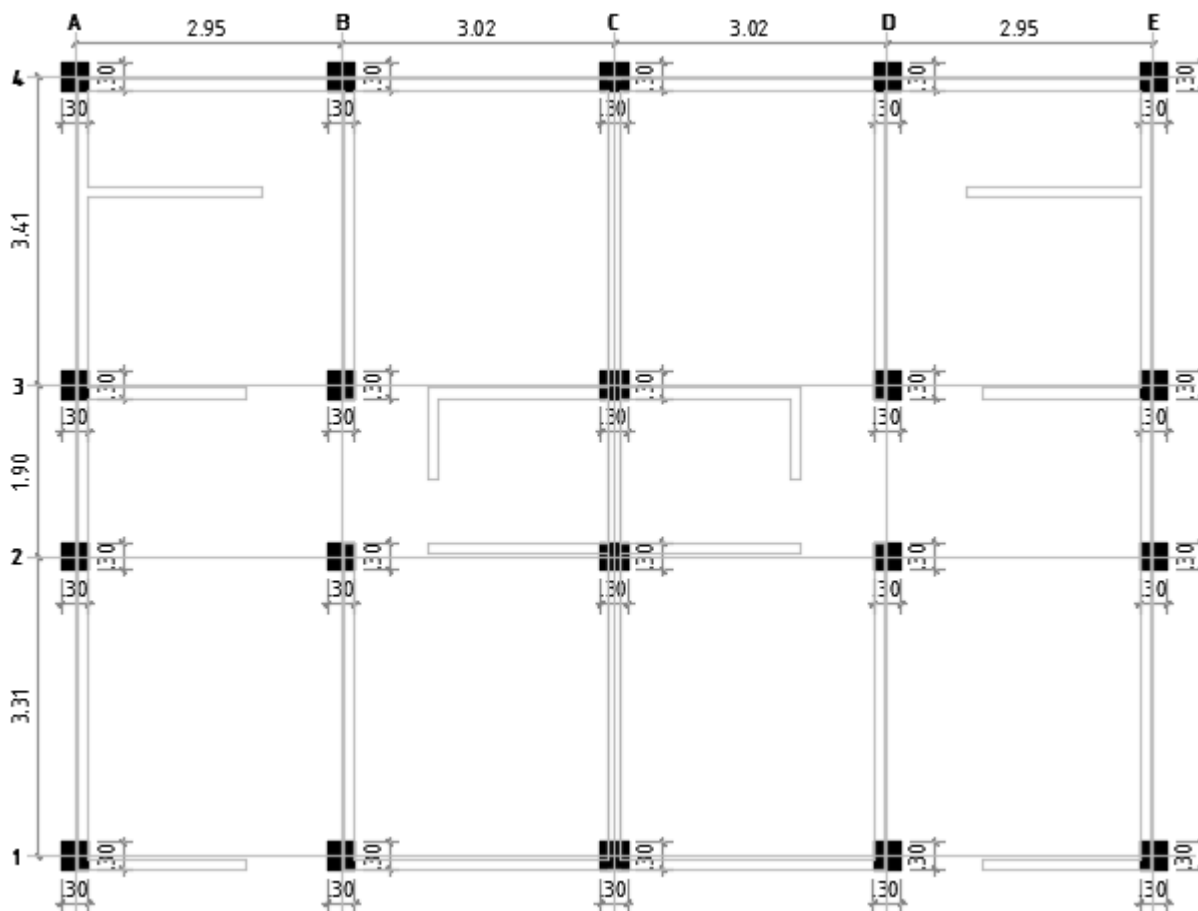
Configuración en planta con la ubicación de las zapatas aisladas
